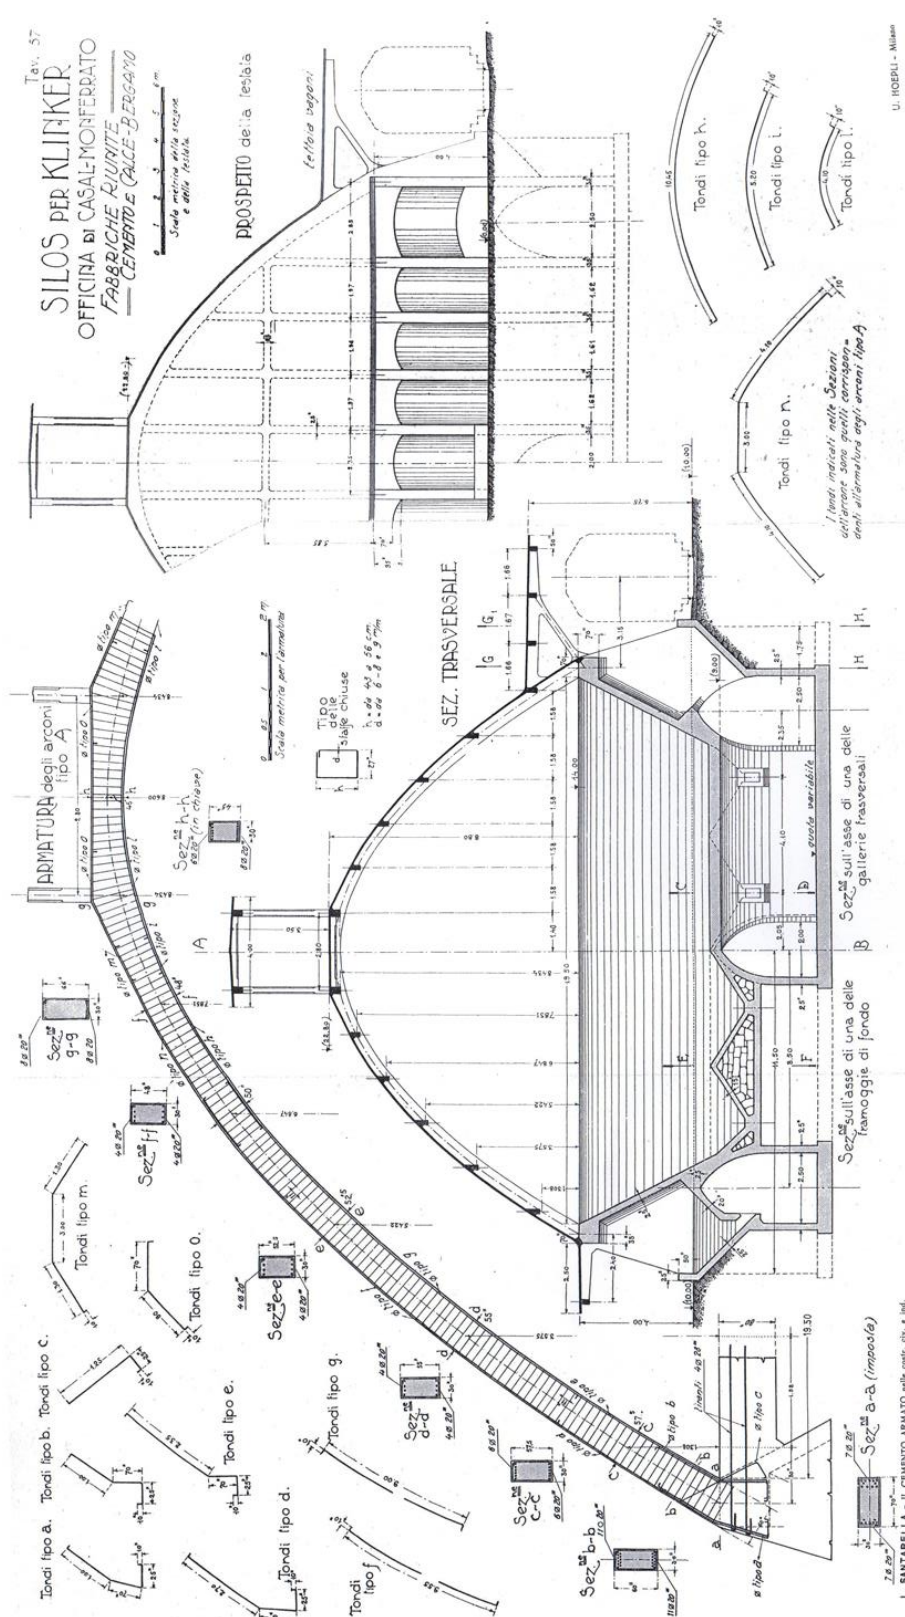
Sezione trasversale, prospetto e dettagli del Paraboloido di Casale Monferrato<sup>1</sup>
